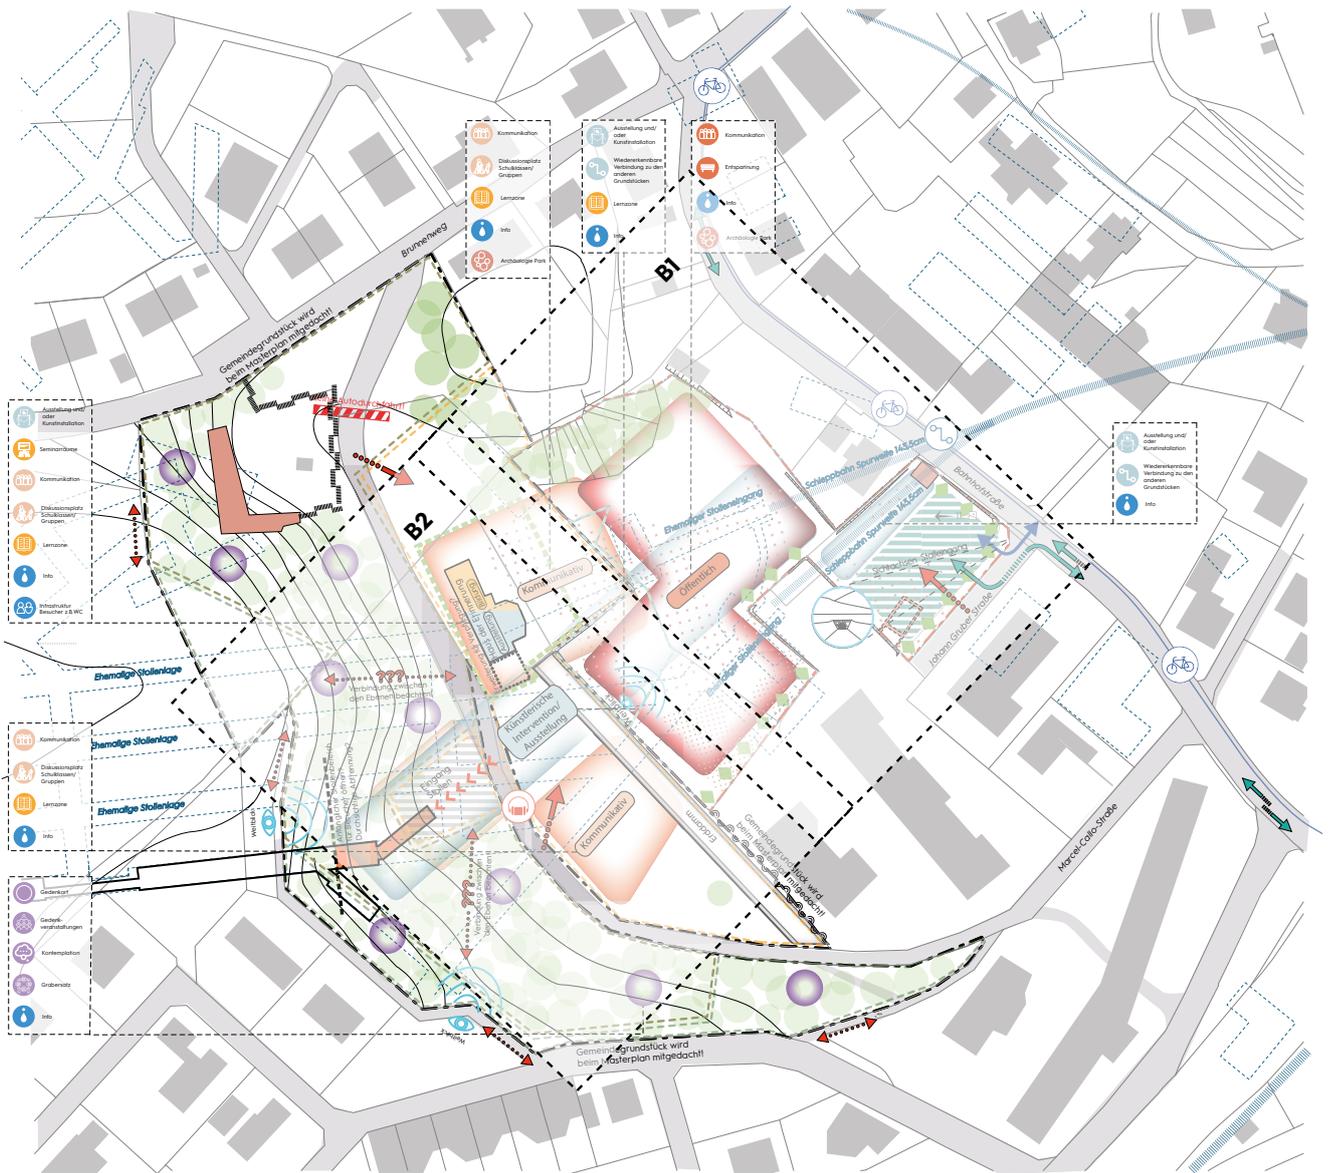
Masterplan Grundriss „Bergkristall“ (Ausschnitte B1 und B2 werden auf den Folgeseiten dargestellt)
